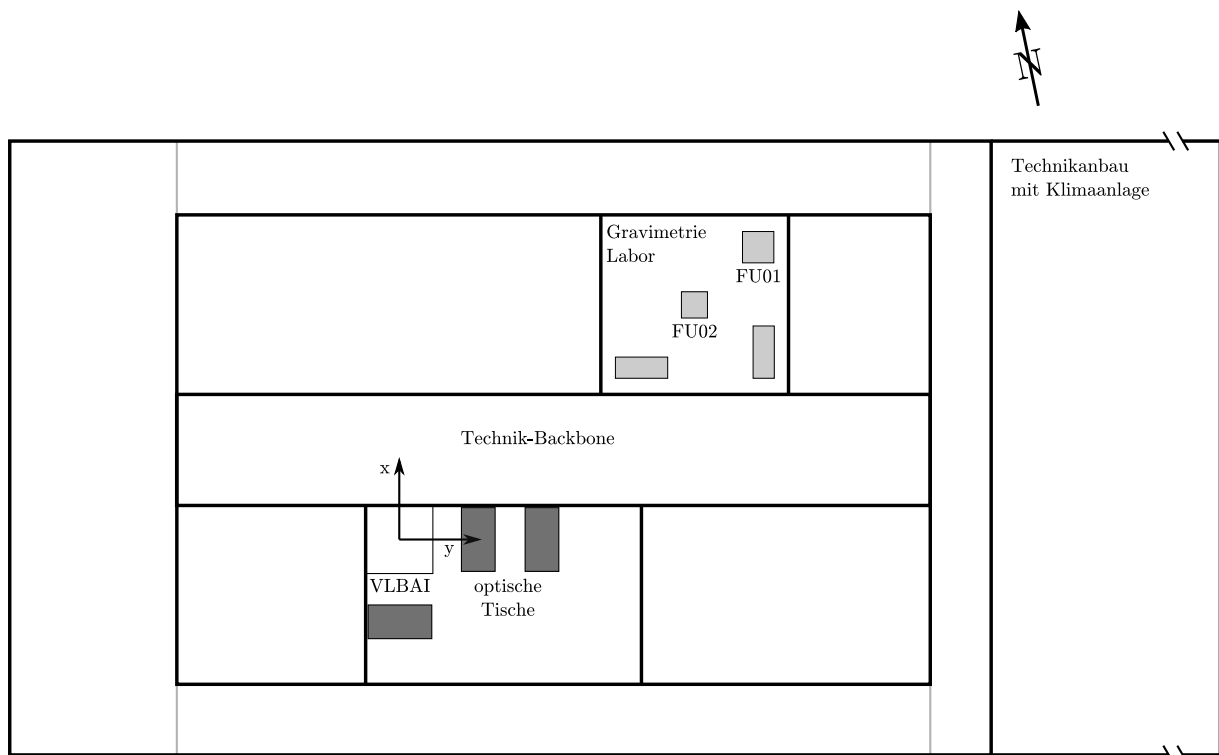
Grundriss des HITec Untergeschoss mit der Lage der VLBAI- und Gravimetrielabore in nicht maßstäblicher Darstellung. Der Technikanbau ist stark verkürzt dargestellt.
